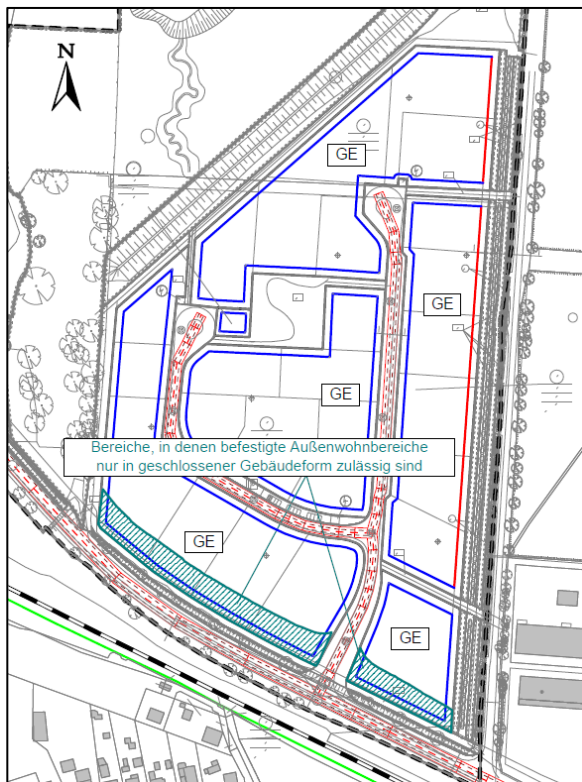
Darstellung des Bereiches, in dem Außenwohnbereiche nur in geschlossener Gebäudeform zulässig sind; Quelle: LairmConsult
